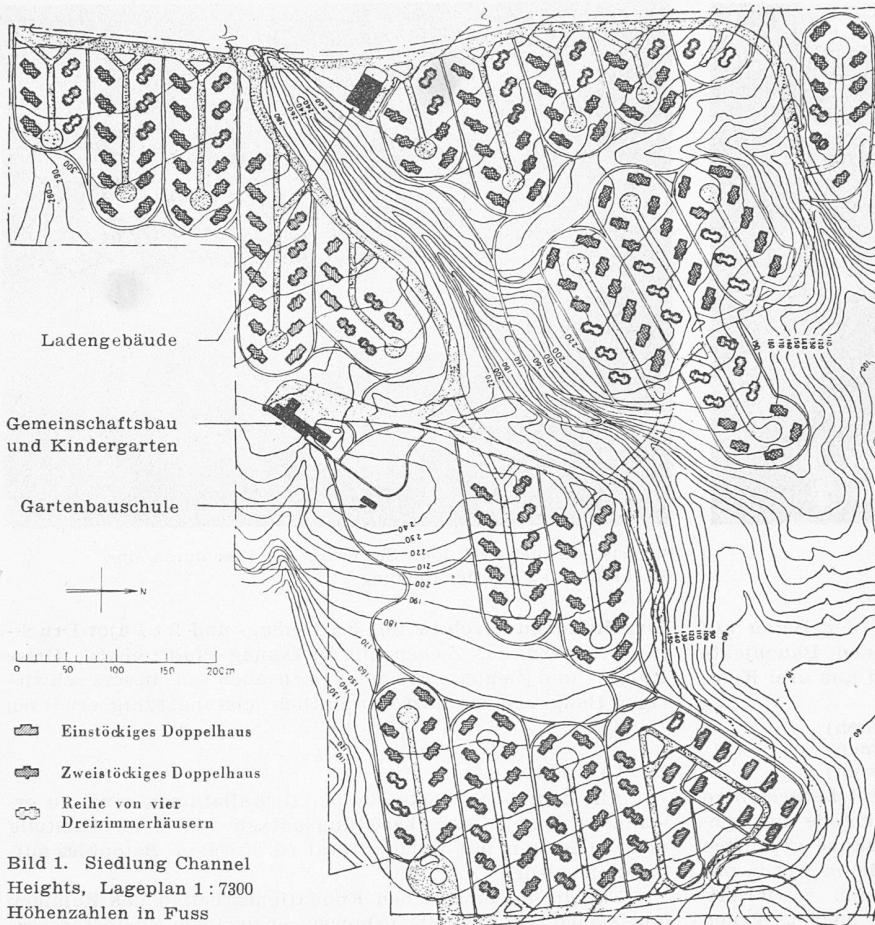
Siedlung Channel Heights, Lageplan 1 : 7300 Höhenzahlen in Fuss
